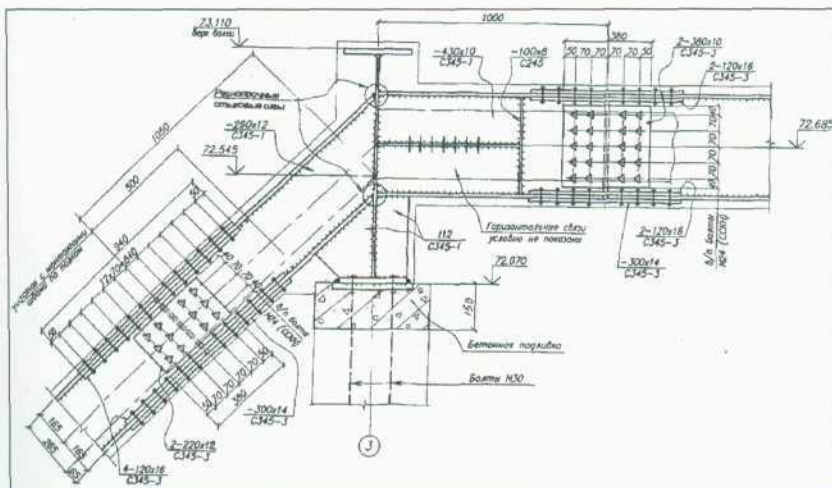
Узел сопряжения главной балки верхнего контура 24x24 м с наклонной наружной колонной и колонной безбалочного перекрытия (узел "Г", рисунок 9)
